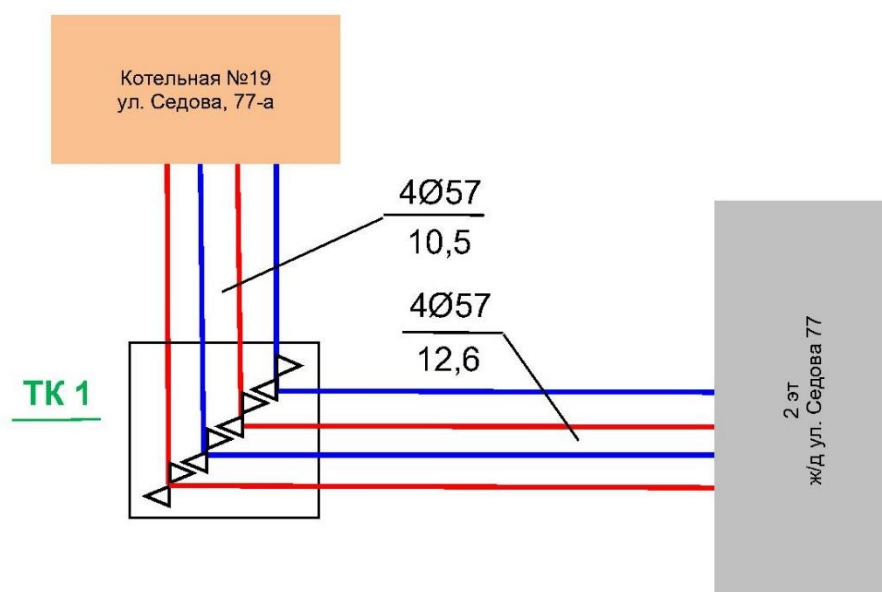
Схема тепловой сети от котельной №19 ул. Седова, 77-а
